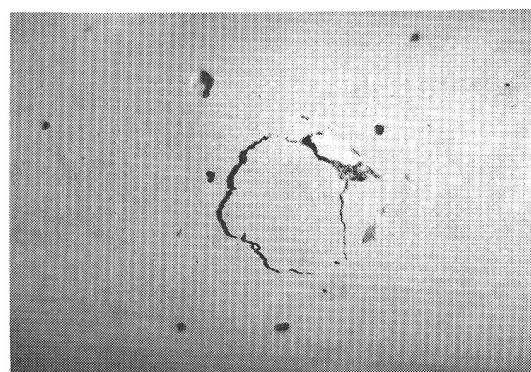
ポップアウトによるコンクリートの膨張ひびわれ
